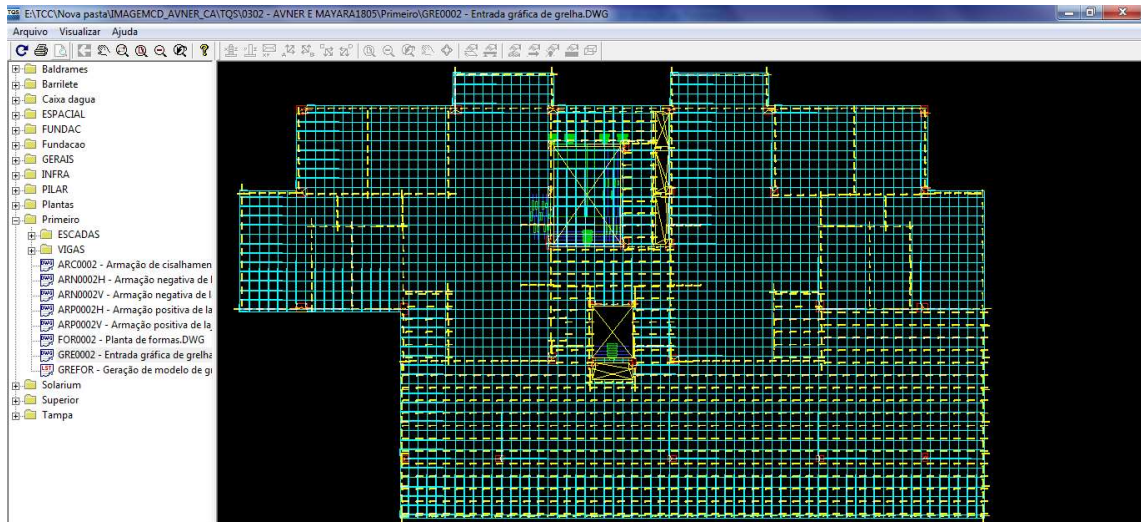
Entrada gráfica de grelha na LLMA de teto do Pavimento Térreo
